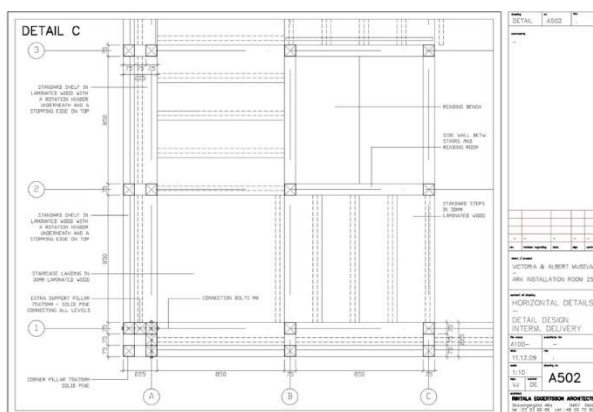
DETALHE CONSTRUTIVO INTERIOR
